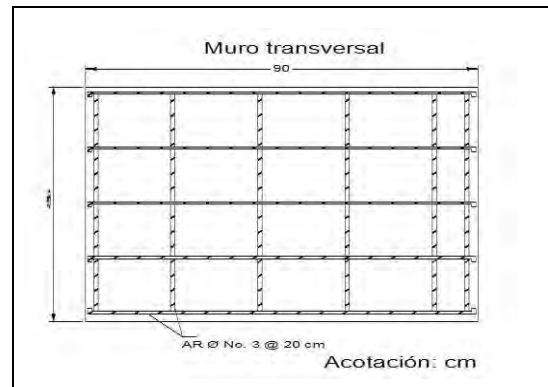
Vista y especificación de muro transversal del cajón prefabricado (Armado estructural de acero reforzado).
